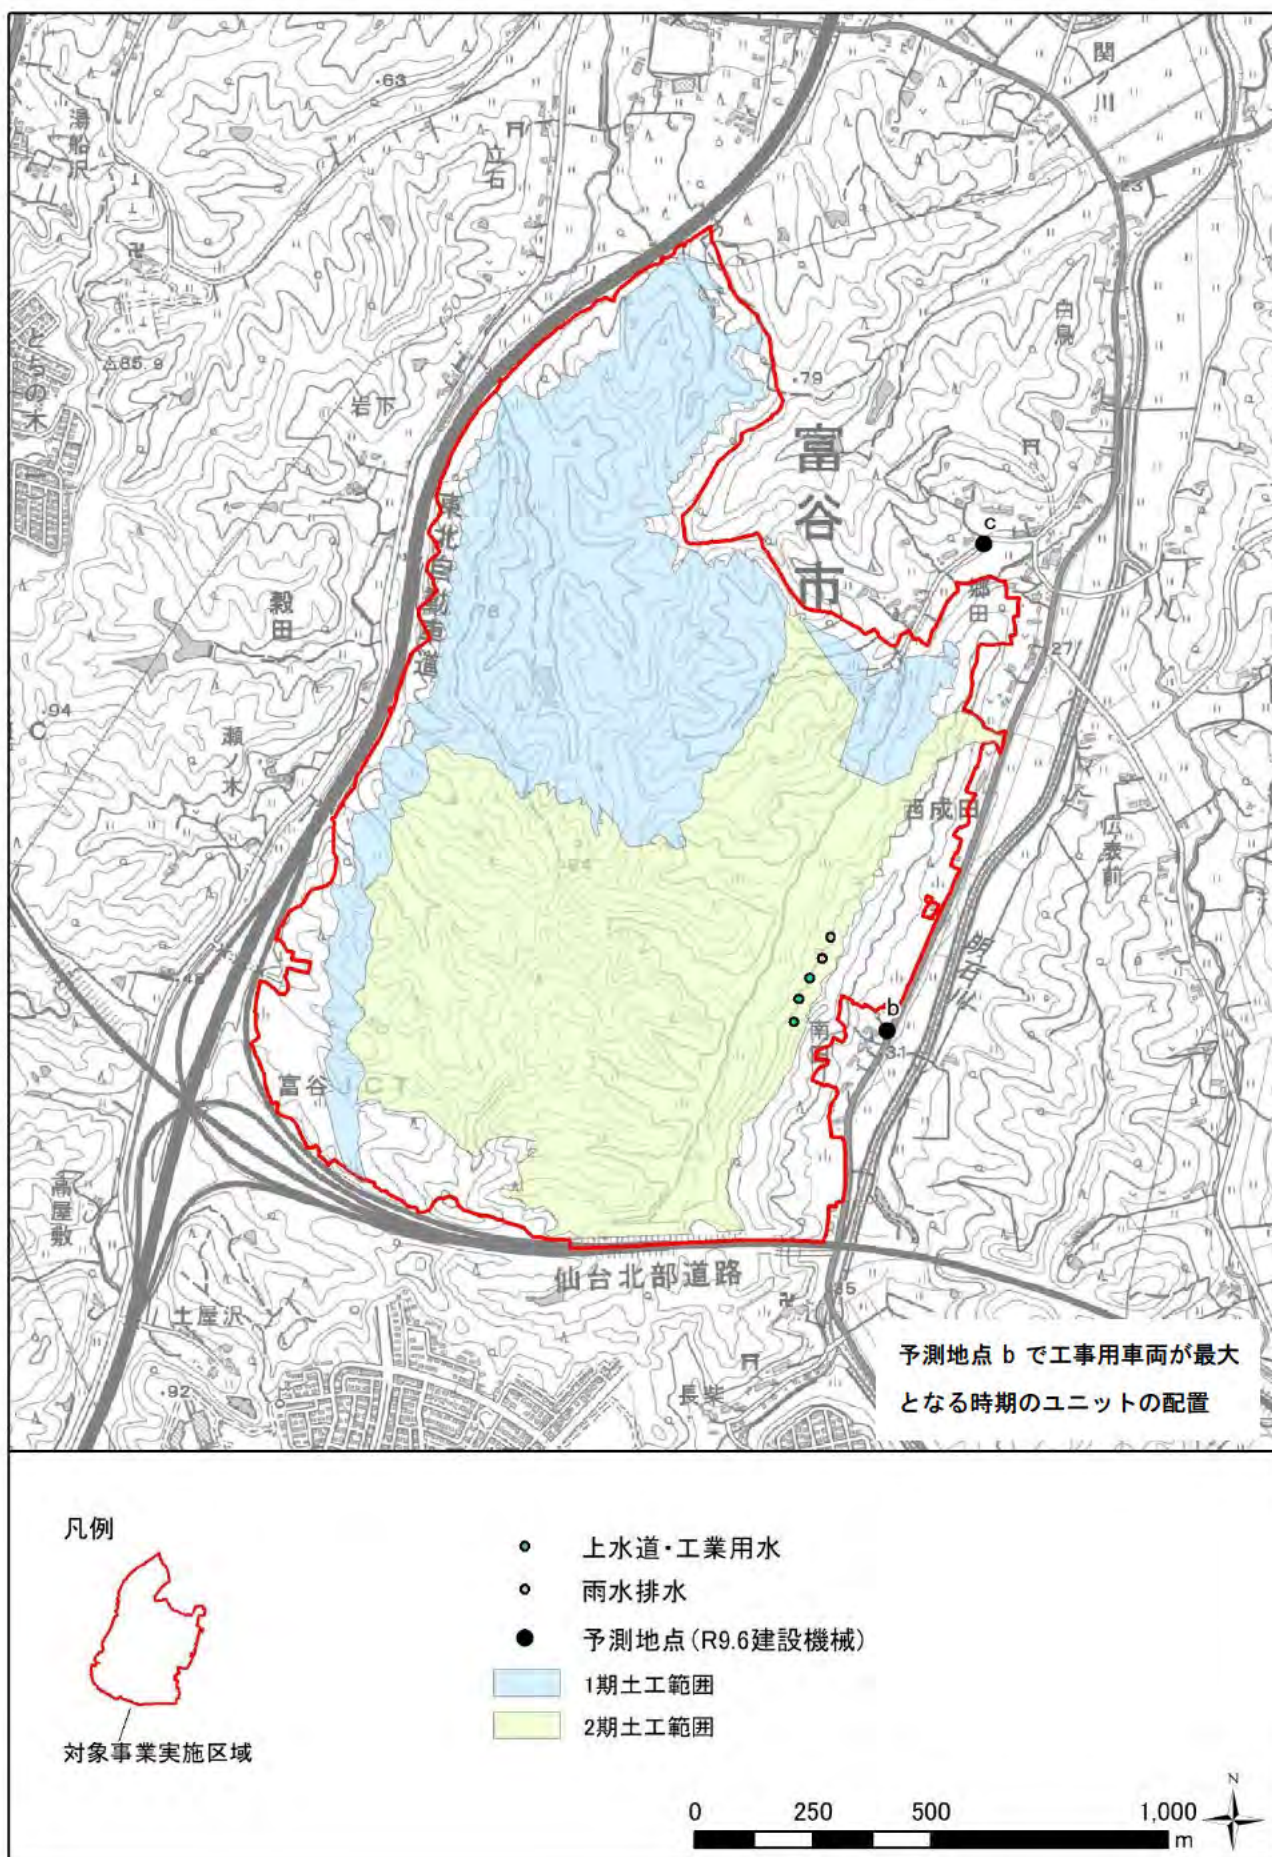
複合騒音予測時期の施工範囲及びユニットの配置 (R13.5 予測地点b)
